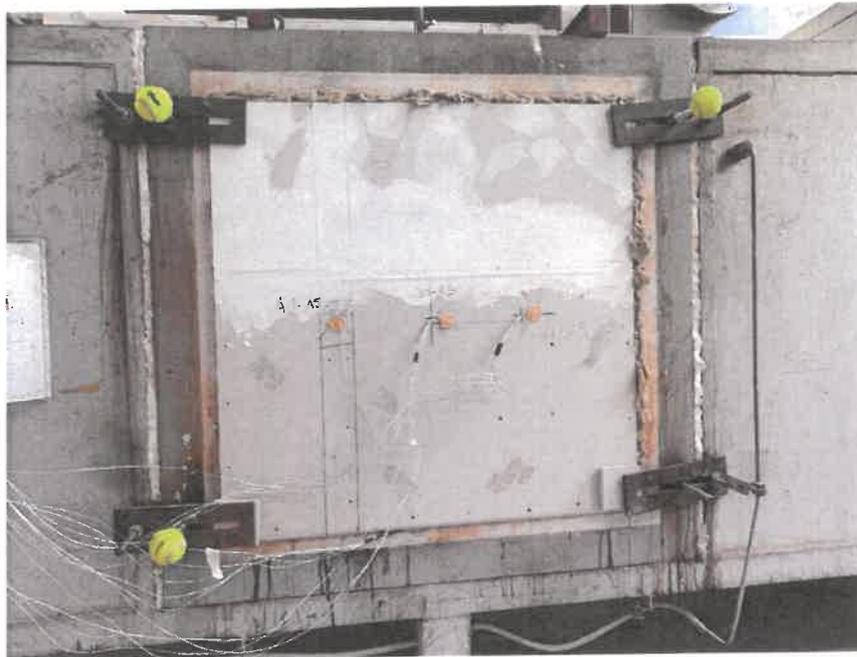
Außenansicht des eingebauten Prüfkörpers vor Prüfbeginn
